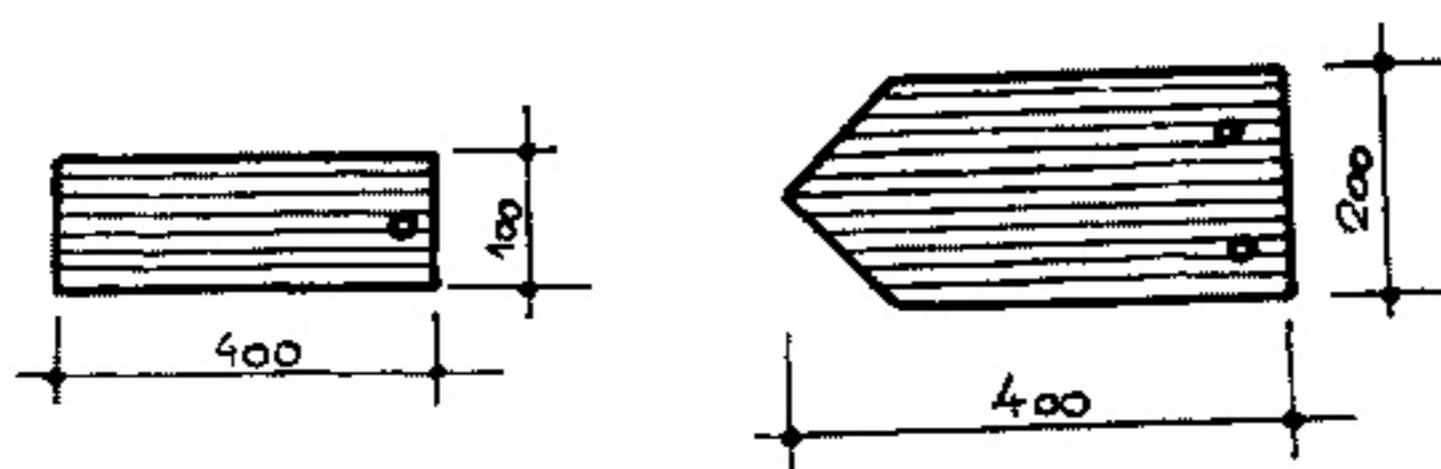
Plăci plane tip șindrilă din azbociment
